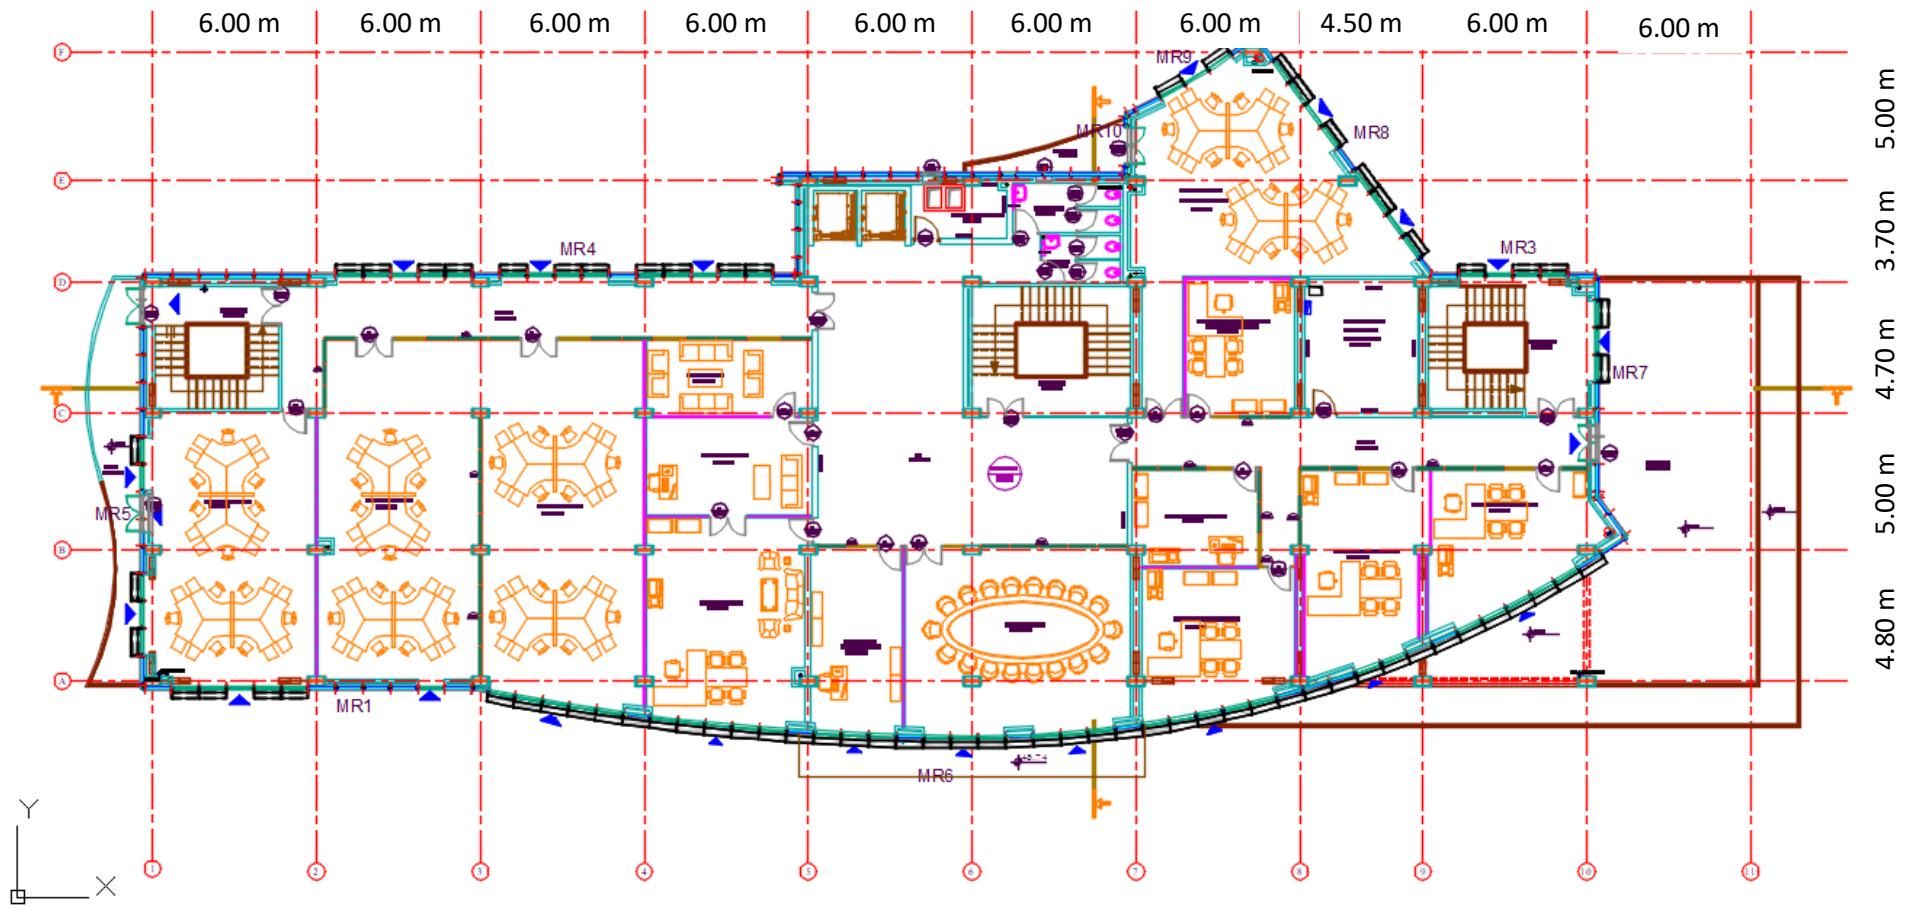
Plan d'architecture du premier étage (Autodesk Autocad)
